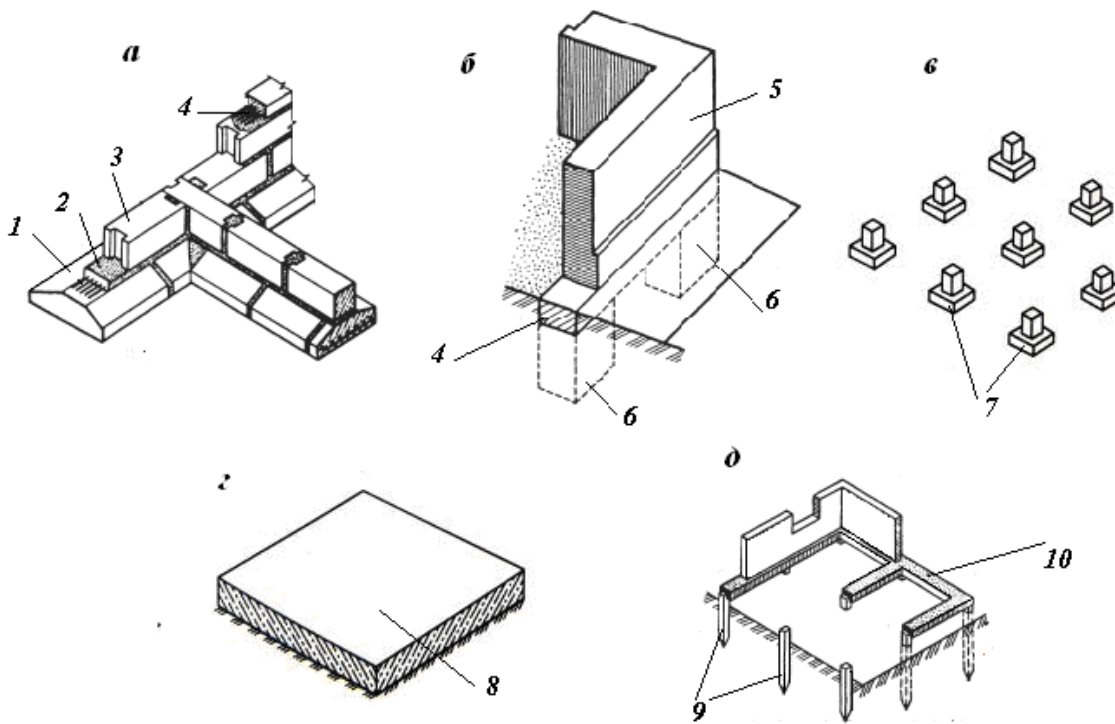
Конструктивні схеми фундаментів: а – стрічковий під стіни; б – стовпчатий під стіни; в – стовпчатий під окремі опори; г – суцільний; д – пальовий; 1 – фундамента плита; 2 – армований шов; 3 – бетонний блок фундаменту; 4 – армований пояс; 5 – стіна; 6 – стовпчасті фундаменти; 7 – стовпчатий блок під окремі опори; 8 – плита; 9 – паля; 10 – ростверк
